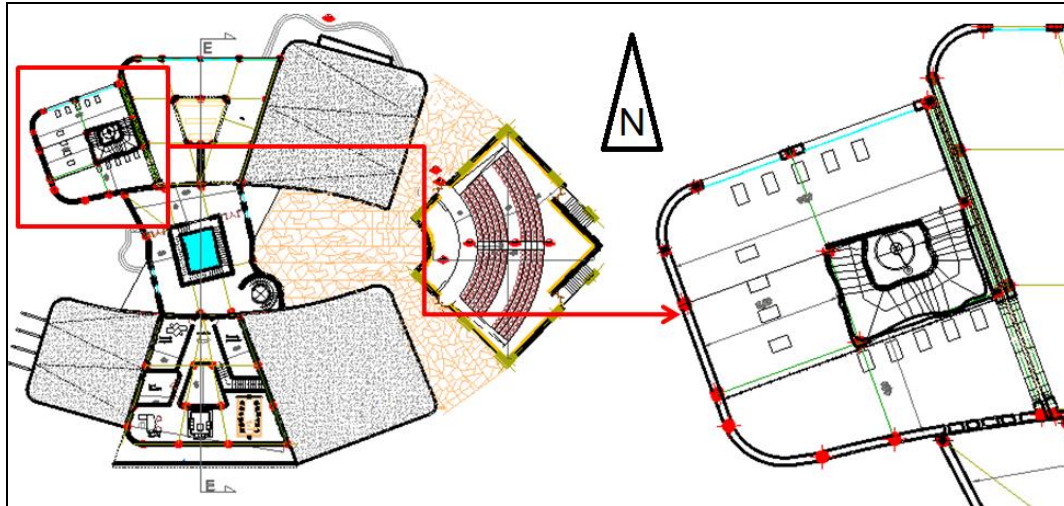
la disposition de la salle d'exposition sur le plan Source : Auteurs
